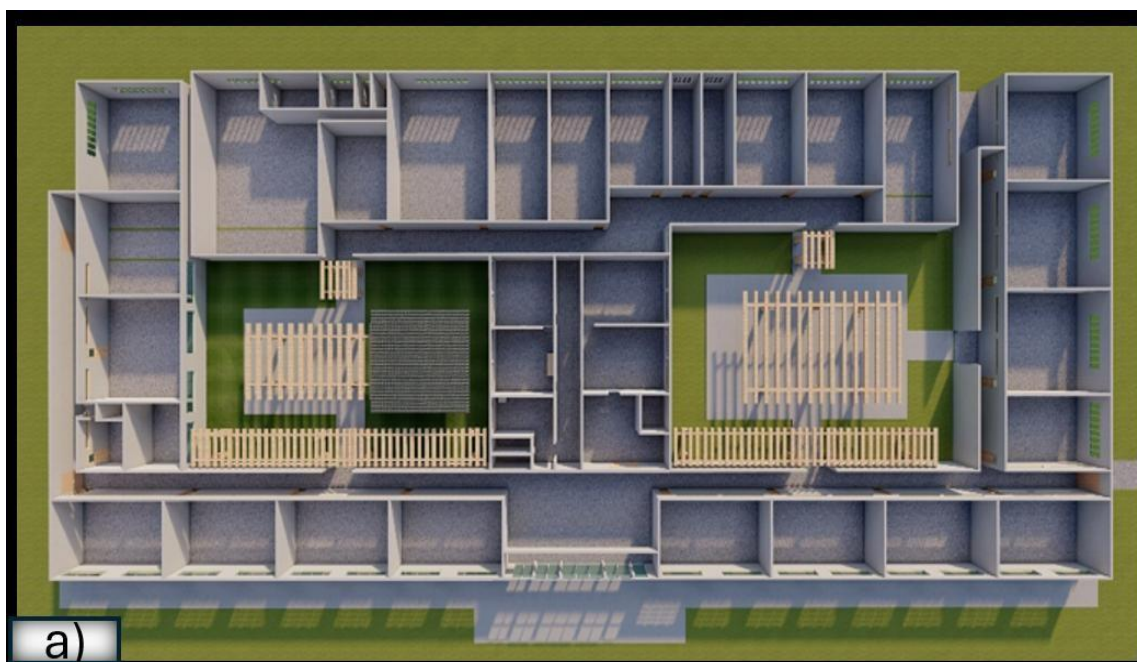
Levantamento técnico hipotético do pavilhão. a) Arquitetônico atual do pavilhão.
